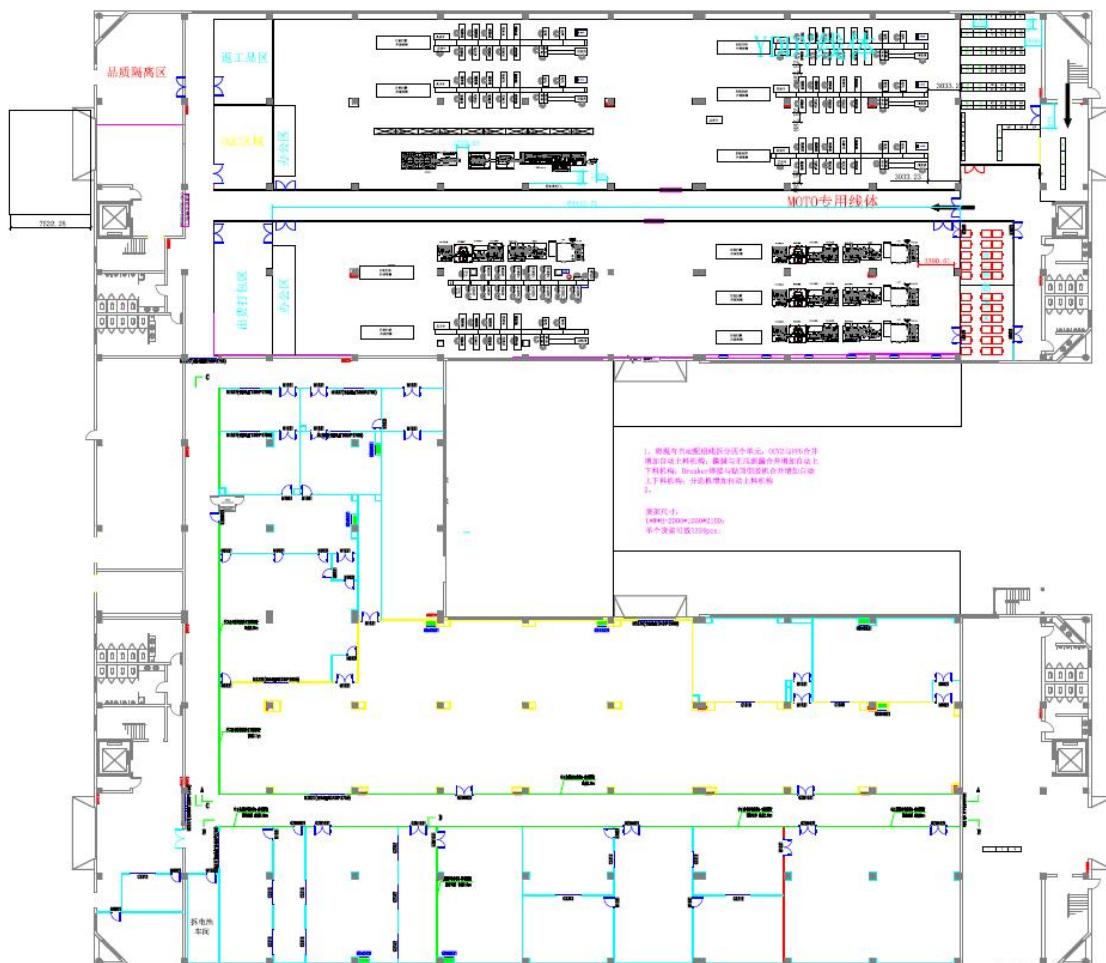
港西大道厂区 AB 栋一楼平面图
